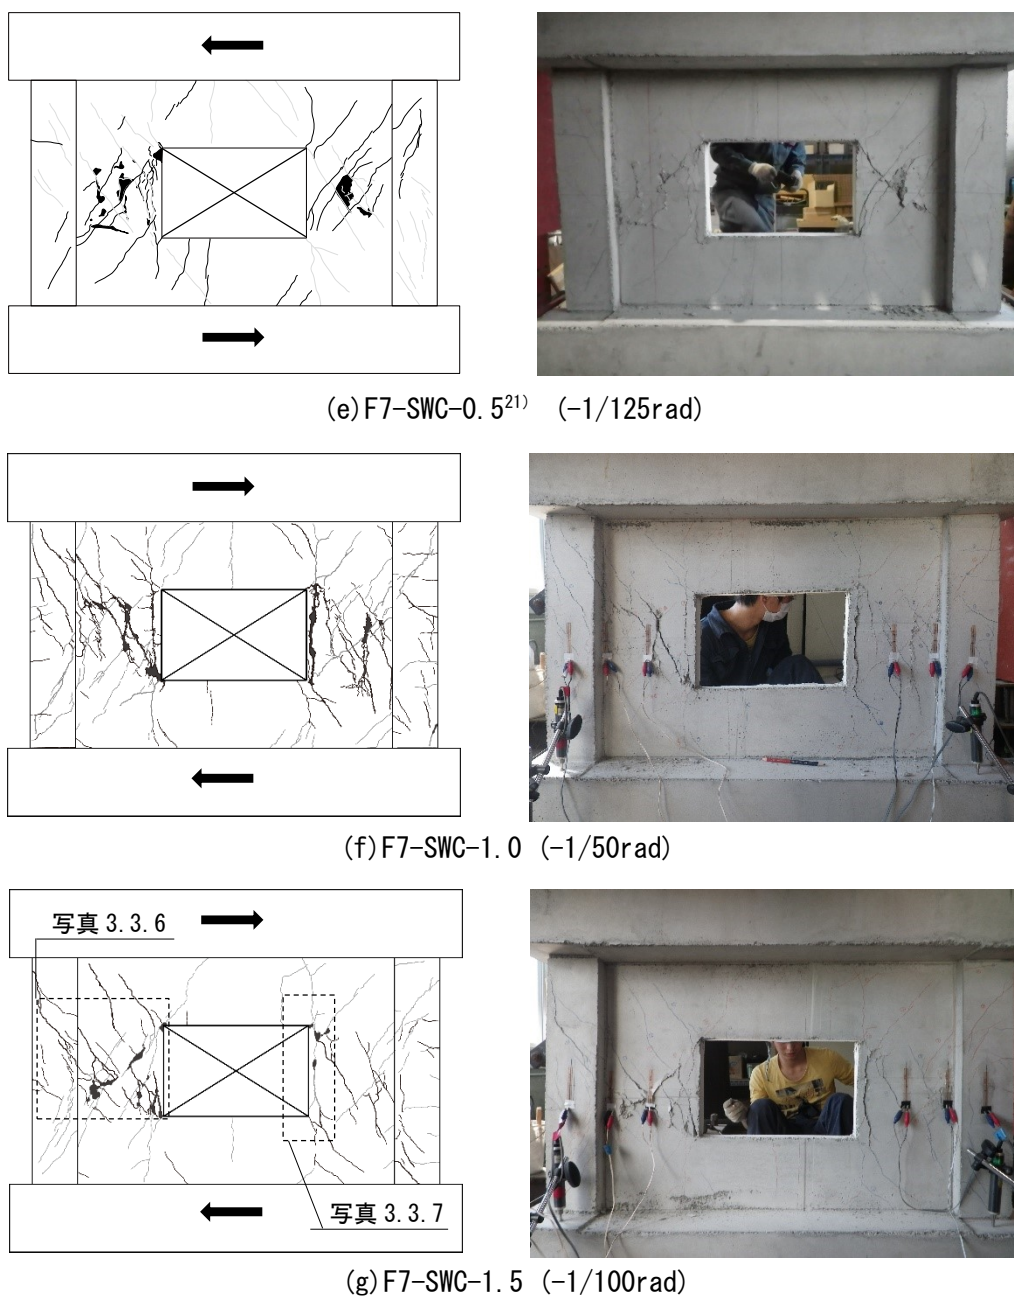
ひび割れ状況図 (→:実験終了時の加力方向)(続き)
